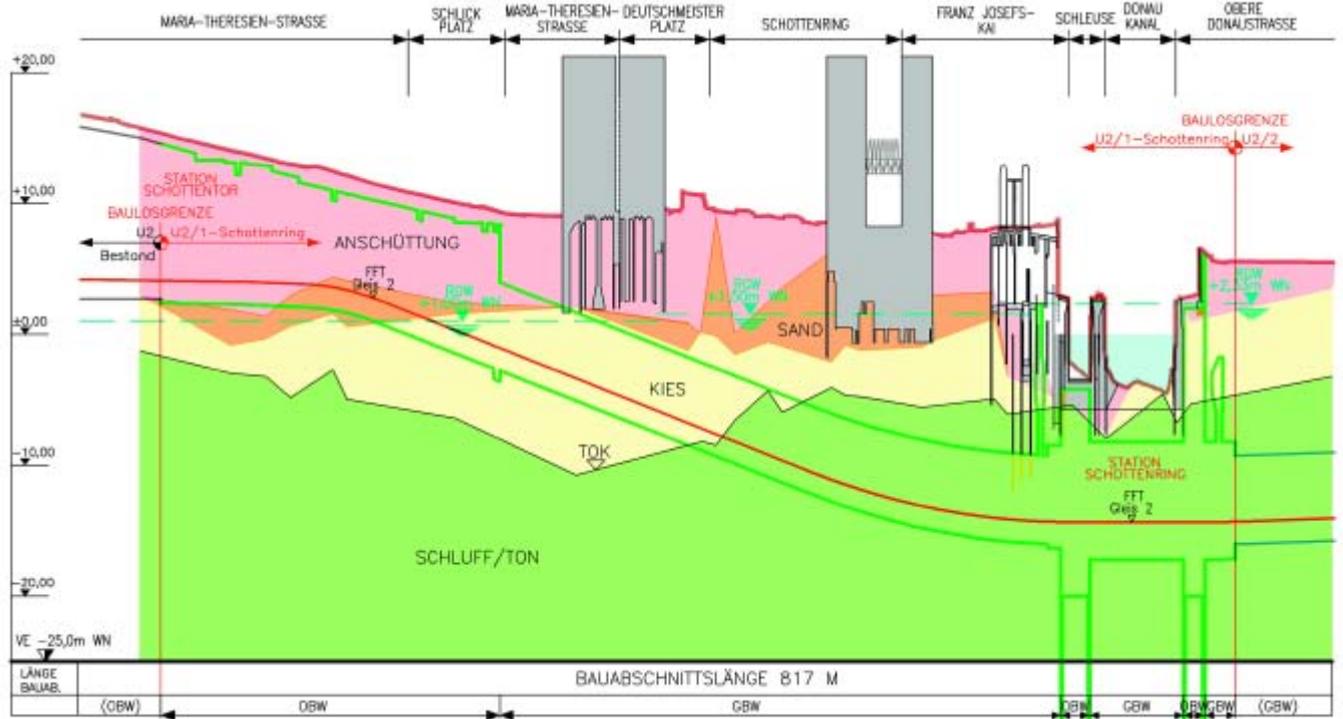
Längsschnitt Baulos U2/1 Schottenring
